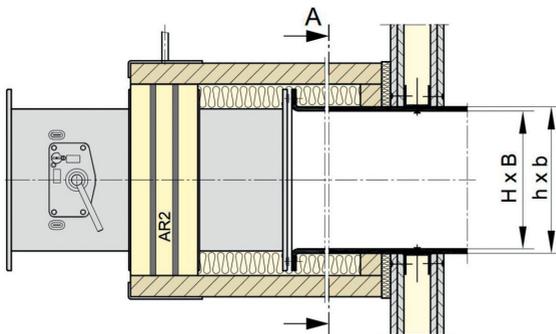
Einbausituation „Bekleidete Lüftungsleitung an Metallständerwände anschließen“ der Brandschutzklappe FK 90 der Fa. Wildeboer. (Quelle: Wildeboer, 2018)
